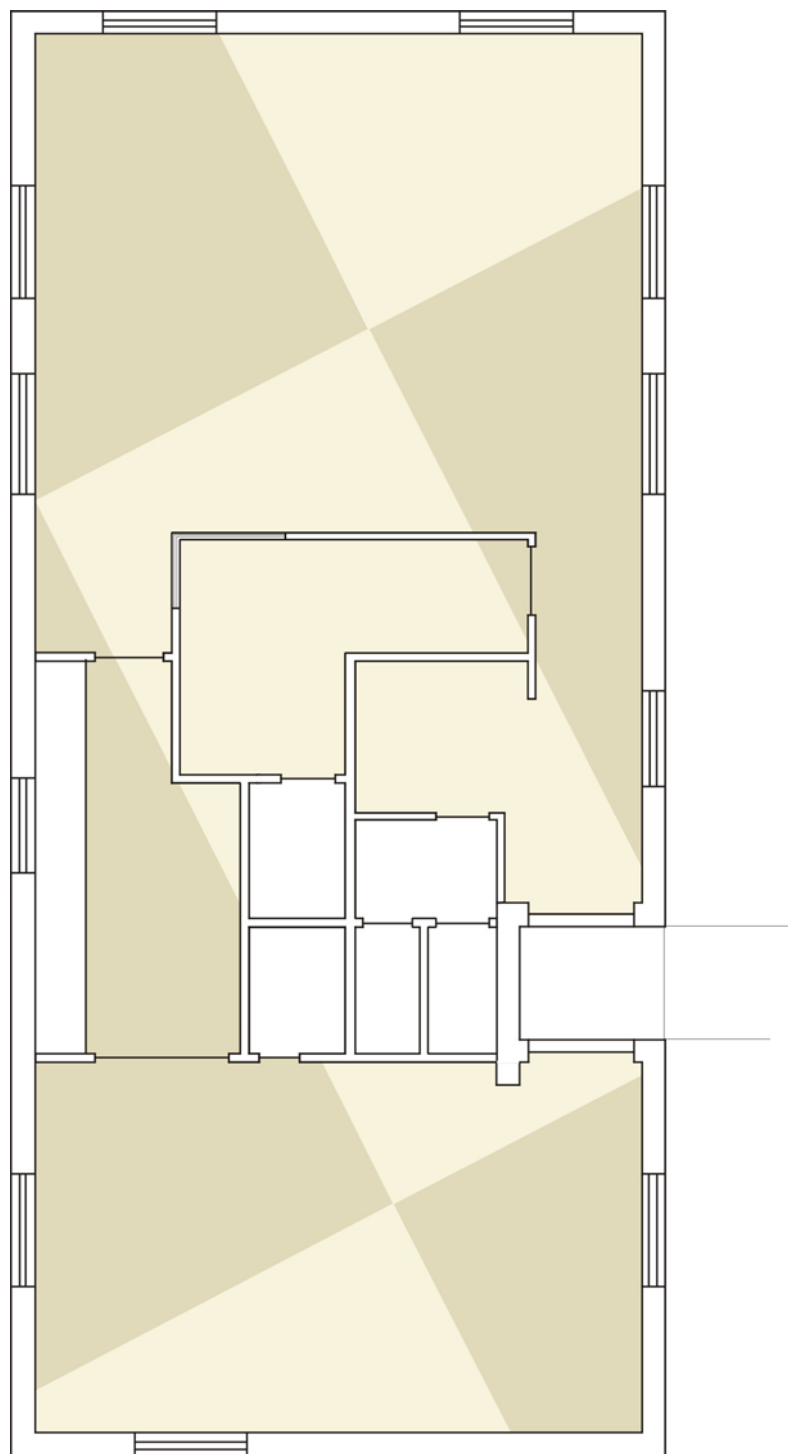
Estudo de propostas para aplicação de linóleo no pavimento
